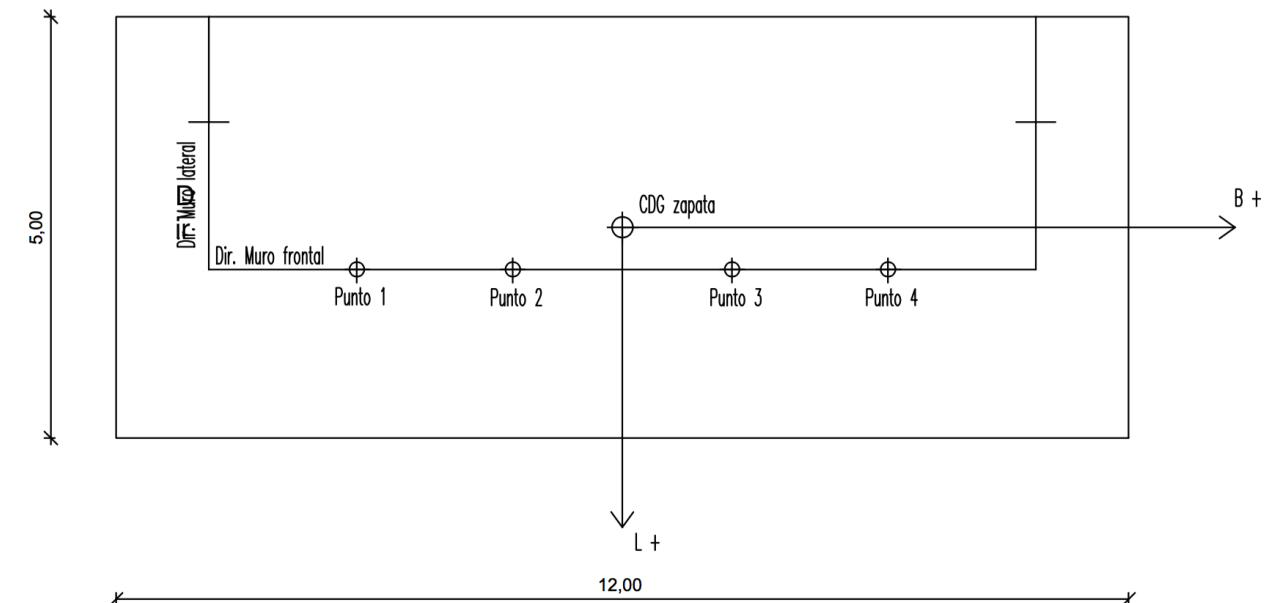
a. Croquis de las cargas en la planta del estribo
